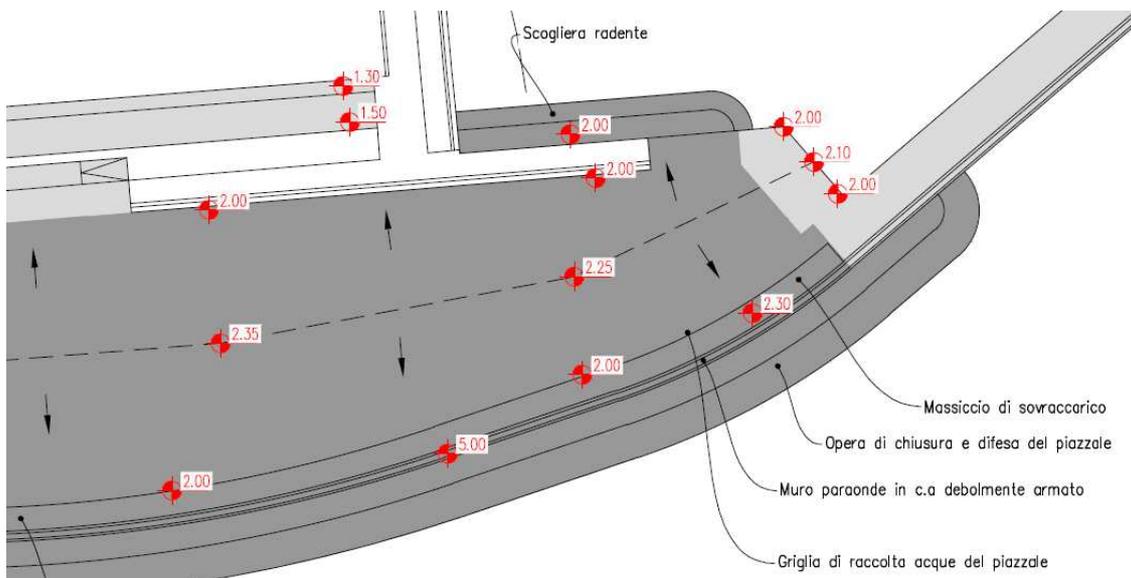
Progetto Definitivo: Stralcio planimetria di progetto
